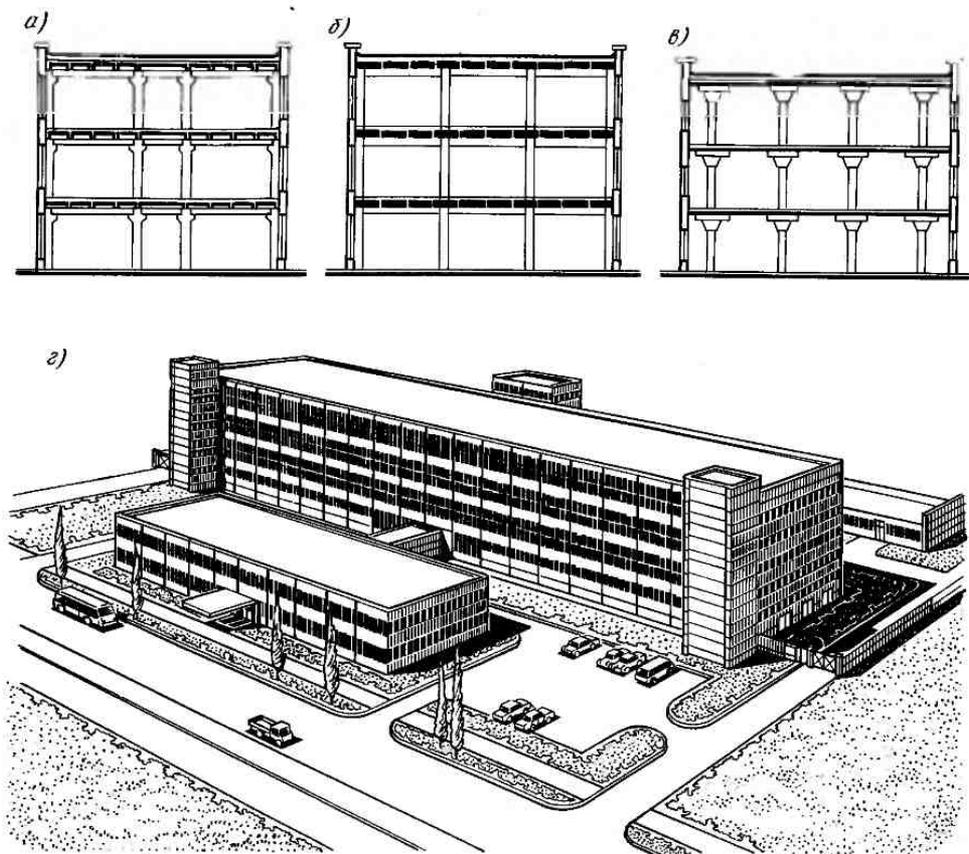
Основные типы многоэтажных промышленных зданий: а--в — схемы поперечных разрезов, г — общий вид здания
